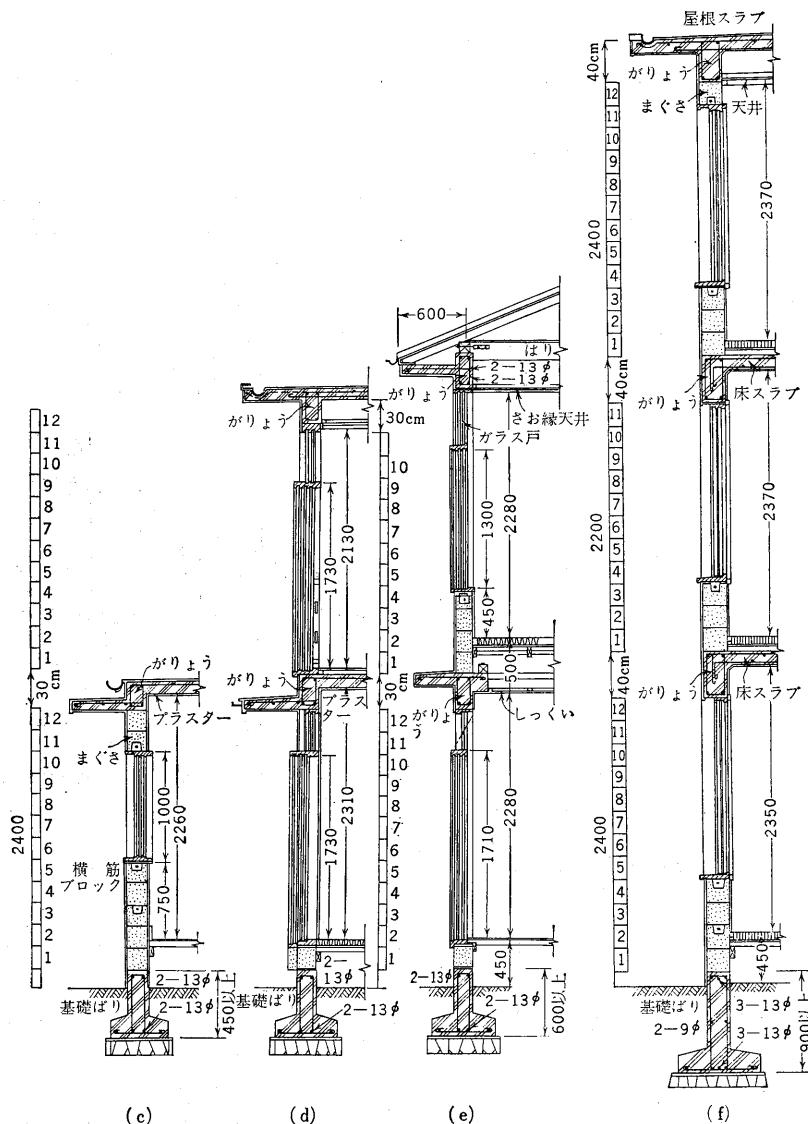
補強コンクリートブロック造建築物の構造(その2)
